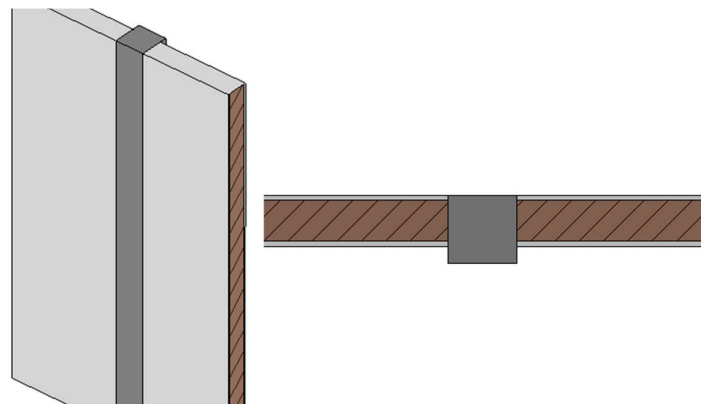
Vista en 3D y en planta del Muro 7.
